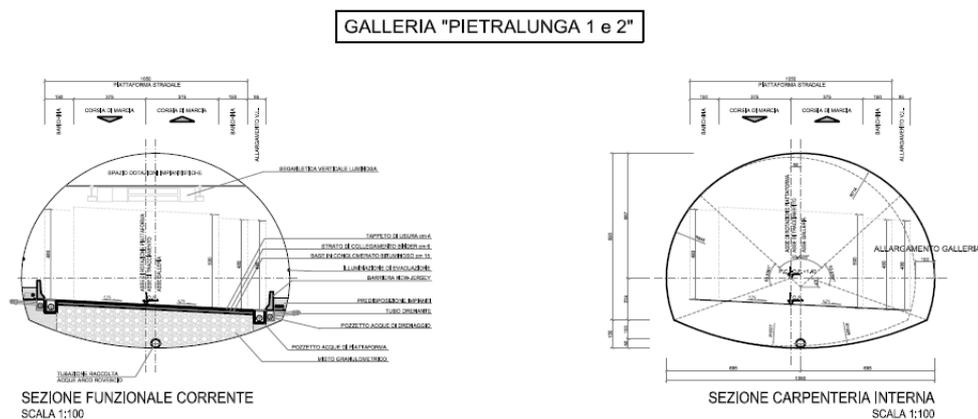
SEZIONE FUNZIONALE DELLE GALLERIE PIETRALUNGA 1 E 2
